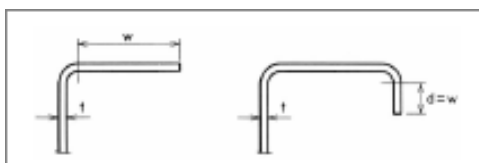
Elemento a compresión rigidizado en un borde. Diseño de Estructuras de Acero Formadas en Frío usando la Especificación AISI 2006. Cristina Ramírez [10].
